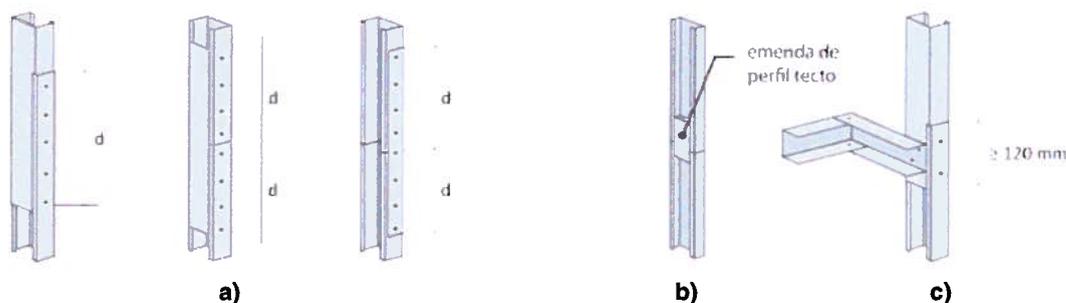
Emendas possíveis em elementos verticais: a) Perfis montante; b) Perfil de tecto; c) Perfil montante com ligação à parede.
